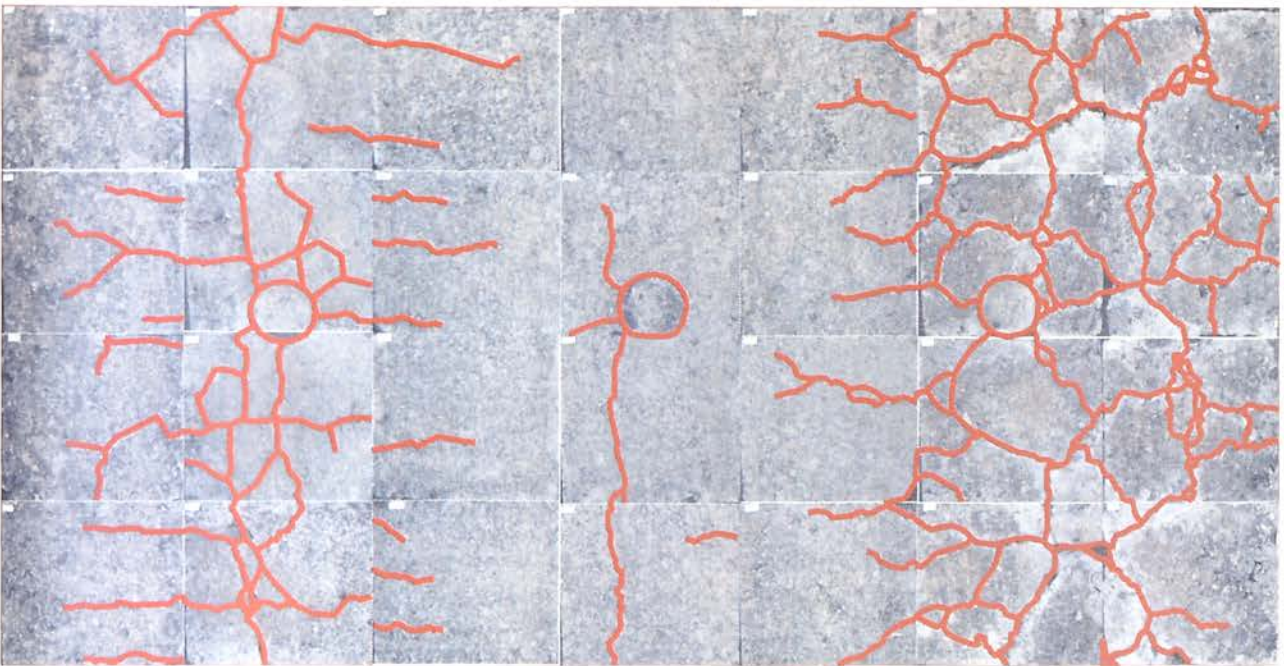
T1-1 断面のひび割れ（底面側）
